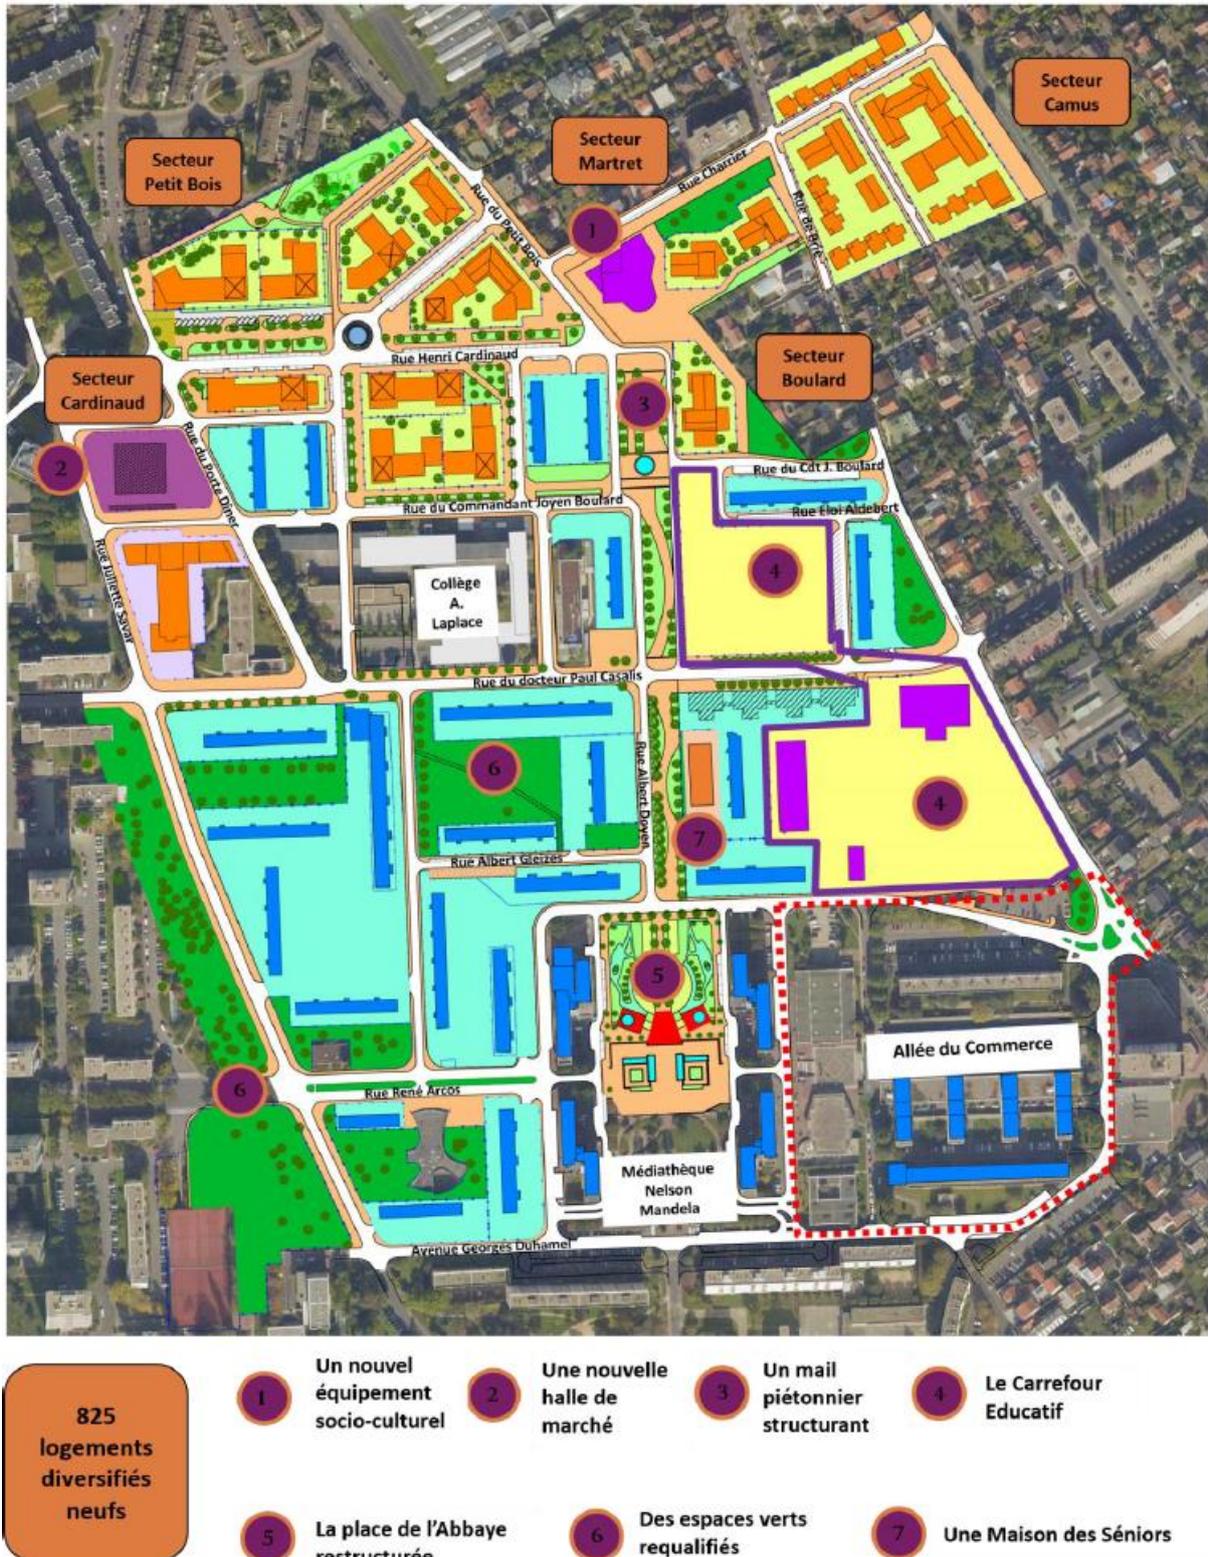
Plan masse projeté du Haut Mont-Mesly
